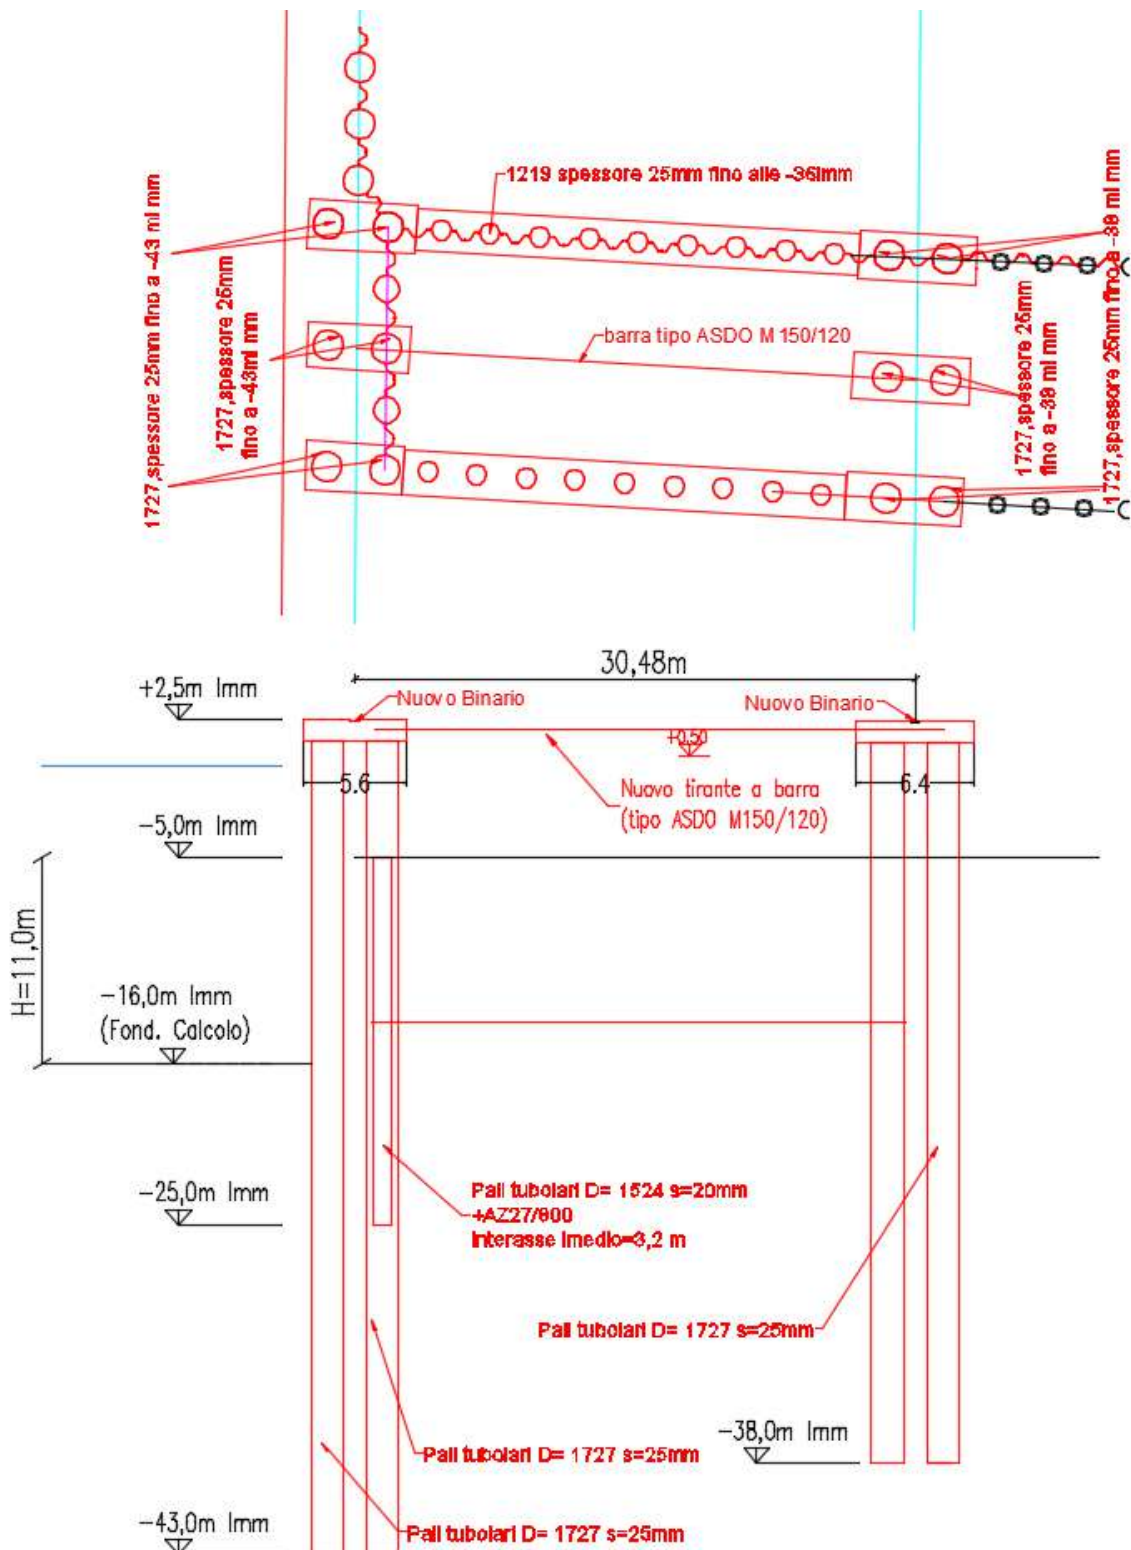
Nuovo Ravano (Melara): sezione rappresentativa dell'intervento
